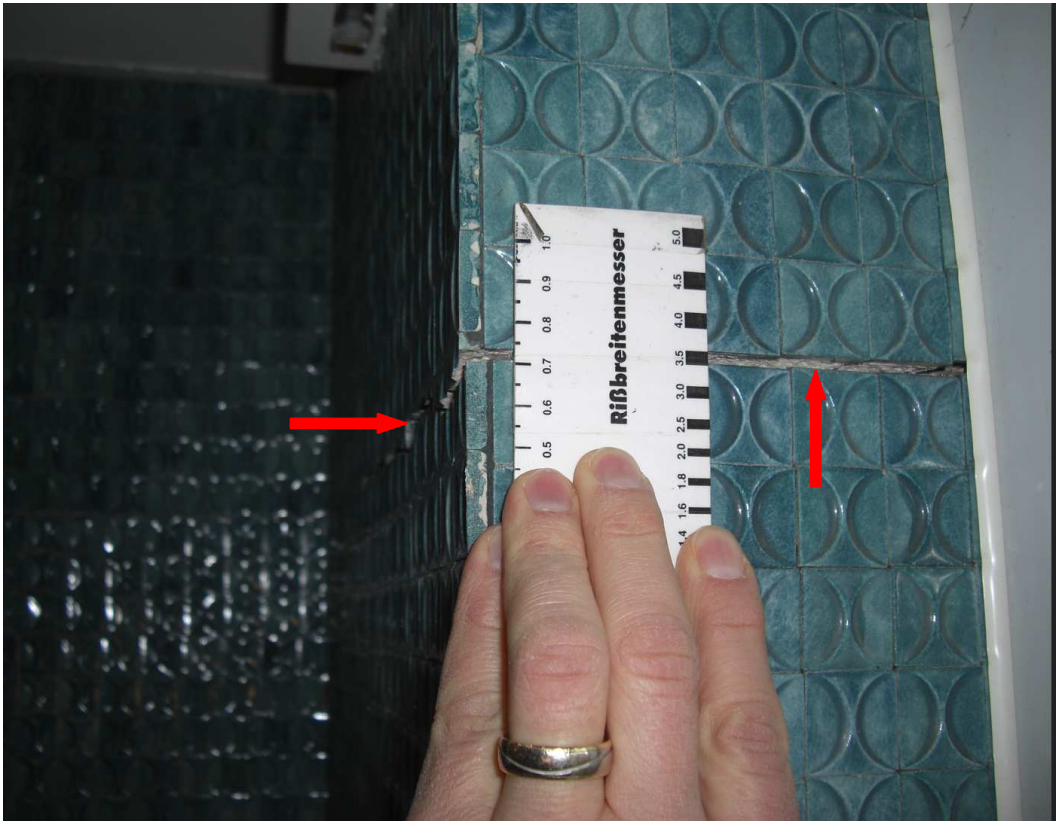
Stirnseite Fensteröffnung Wandriss Eckwand WC
